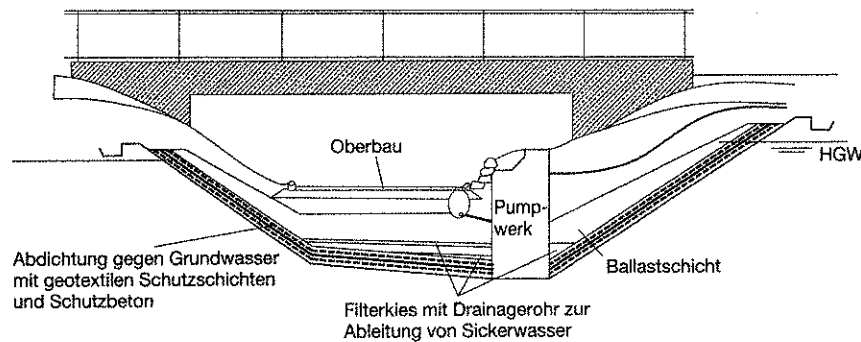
Abdichtung von Bauwerken gegen Grundwasser
